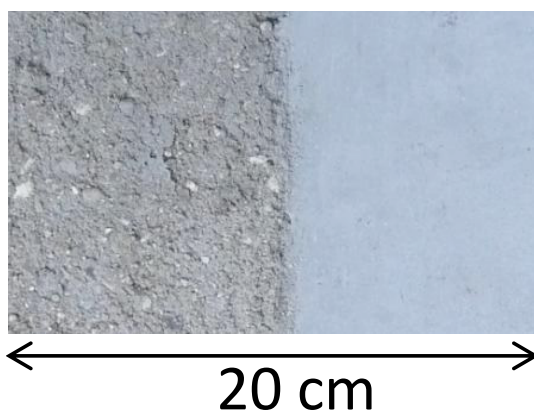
Comparaison entre l'enduit de ciment grossier et l'enduit de ciment fin
